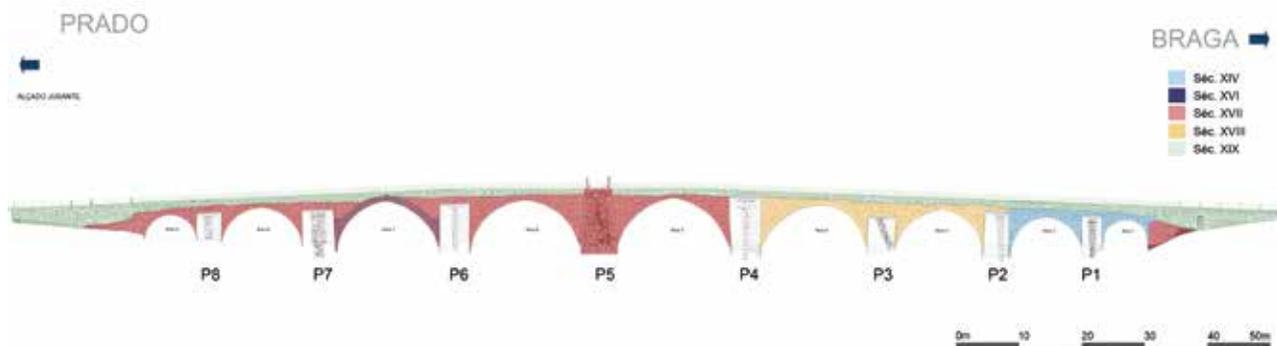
Alçado jusante com indicação das principais fases construtivas¹.
